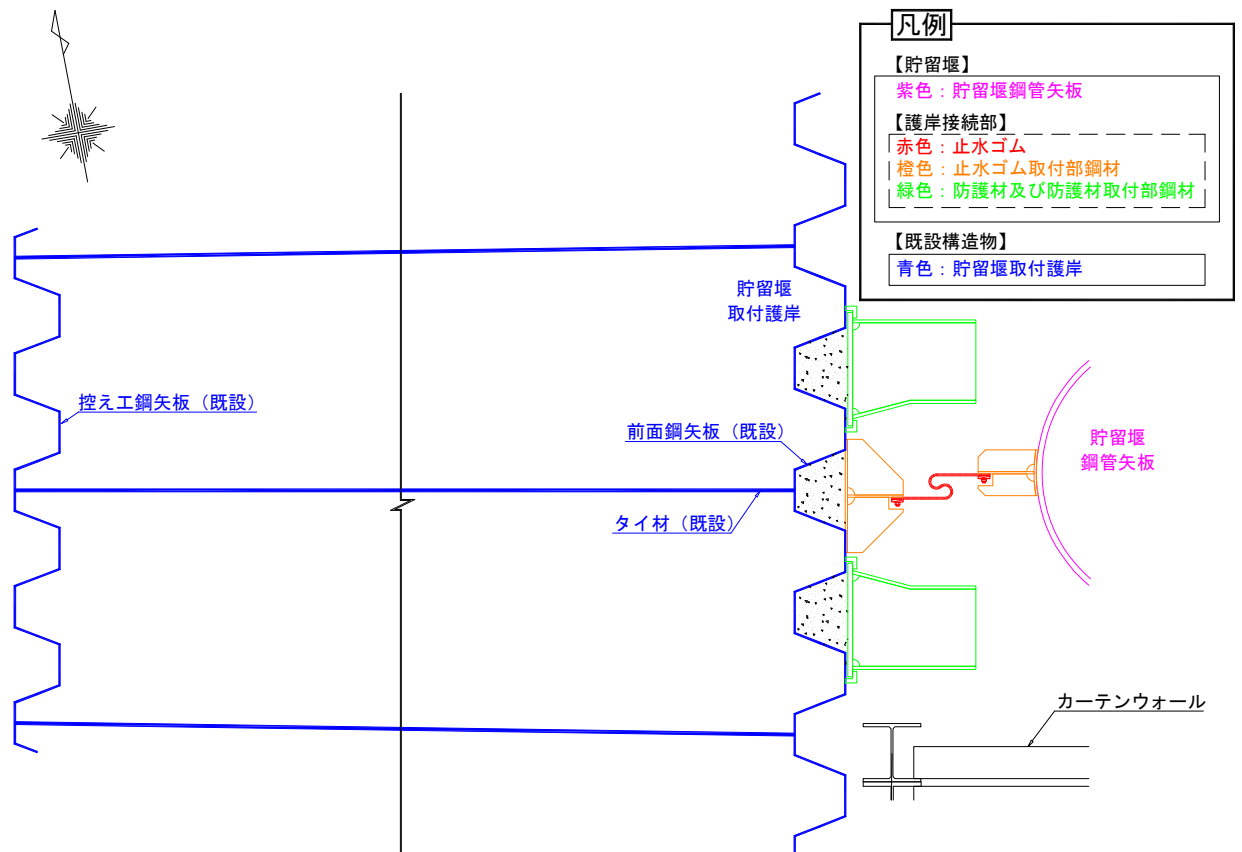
(2) 貯留堰取付護岸の平面図 (A 部拡大)
